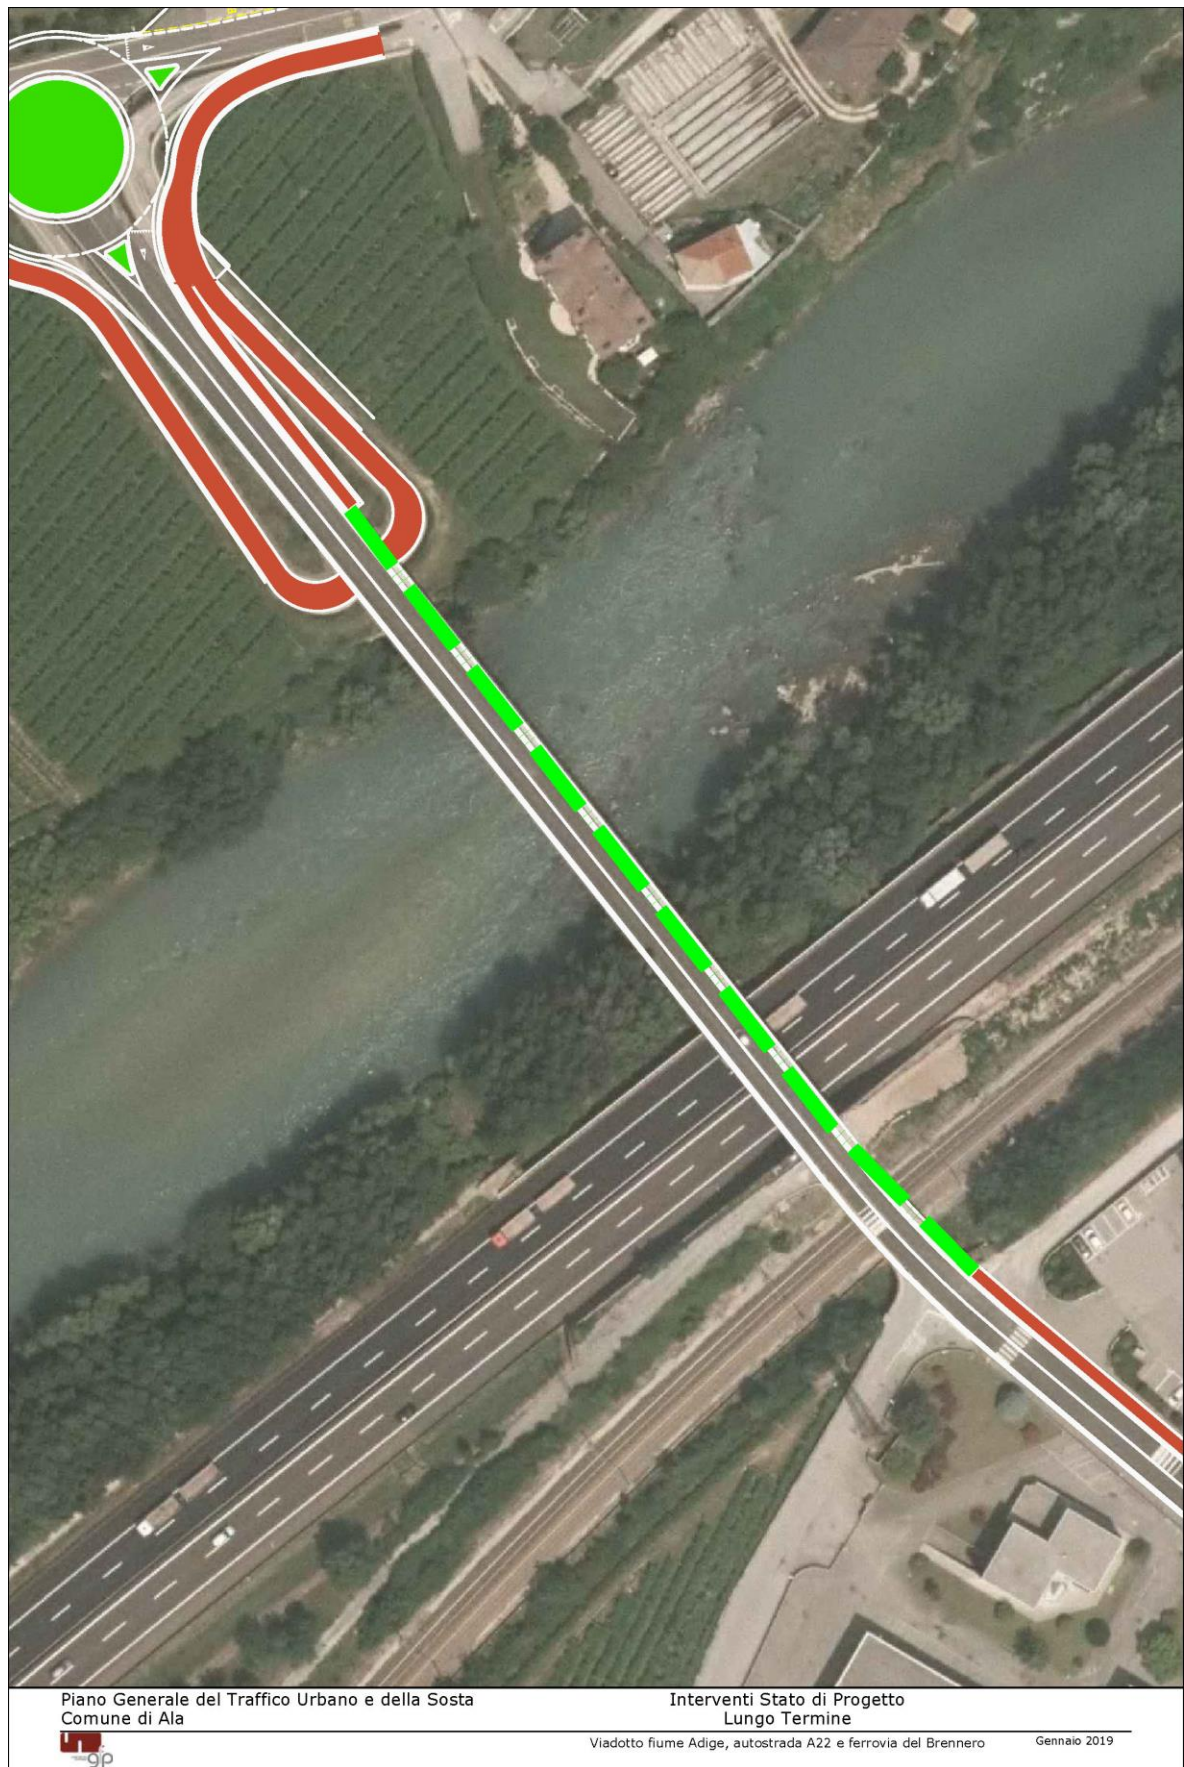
Interventi Stato di Progetto – Lungo Termine – Nuova pista ciclopedonale viadotto fiume Adige – A22 – Ferrovia Brennero
